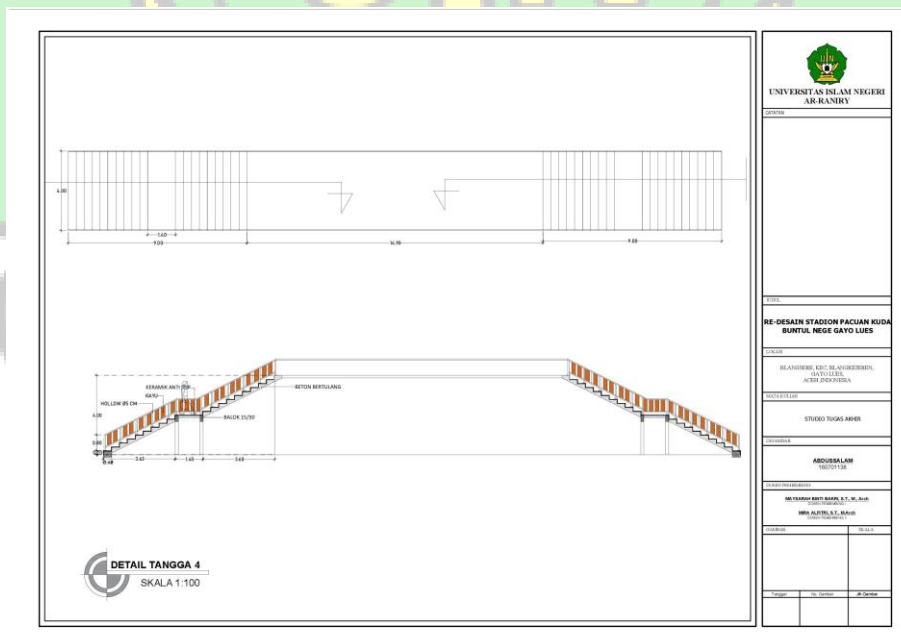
Denah Rencana Tangga Dan Ramp
